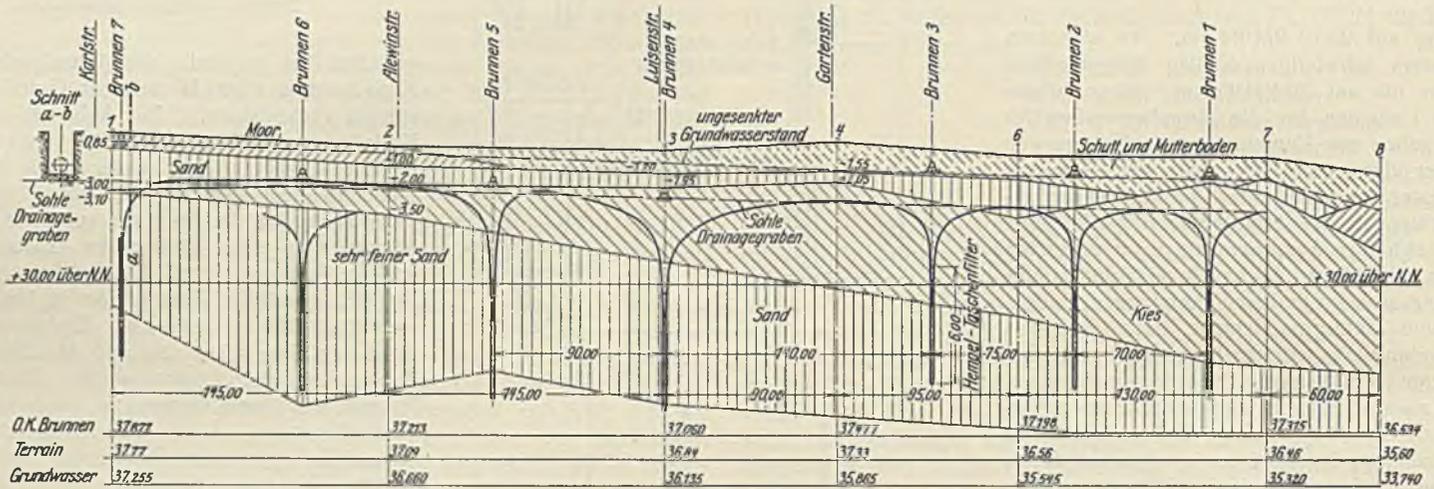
Grundwasserabsenkung für den Nebensammler Dietrichstraße. Längsschnitt.
